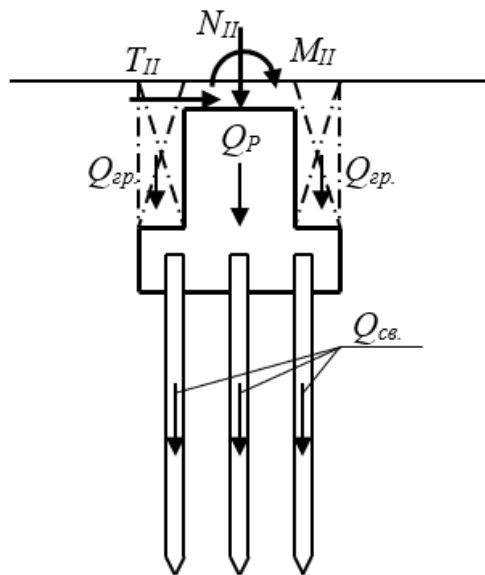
Розрахункова схема пальового фундаменту
